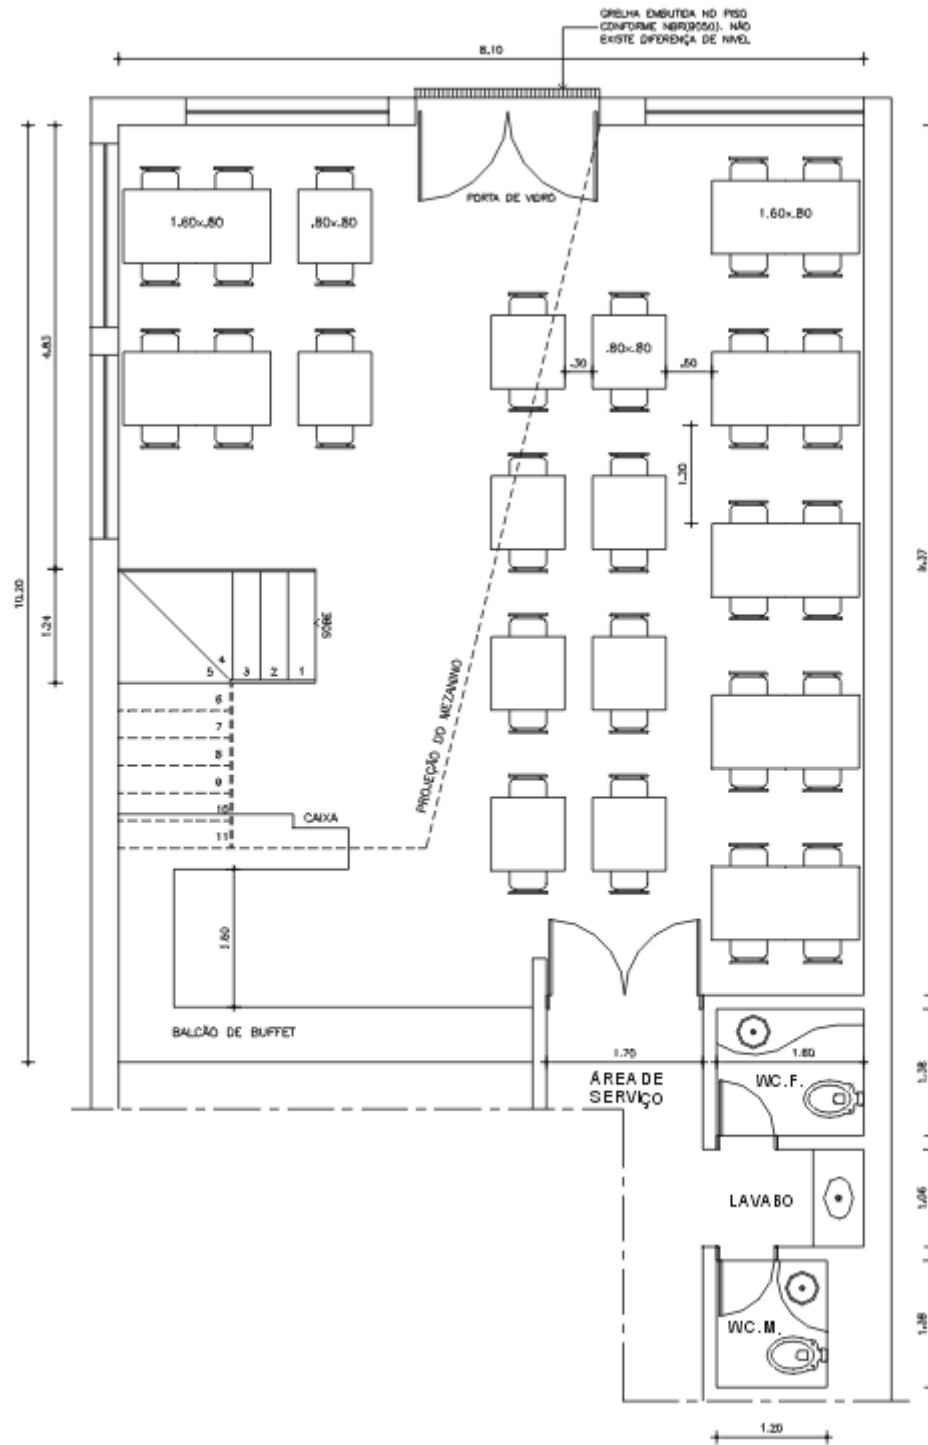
Planta baixa (lay-out) do primeiro pavimento do restaurante “B”.
